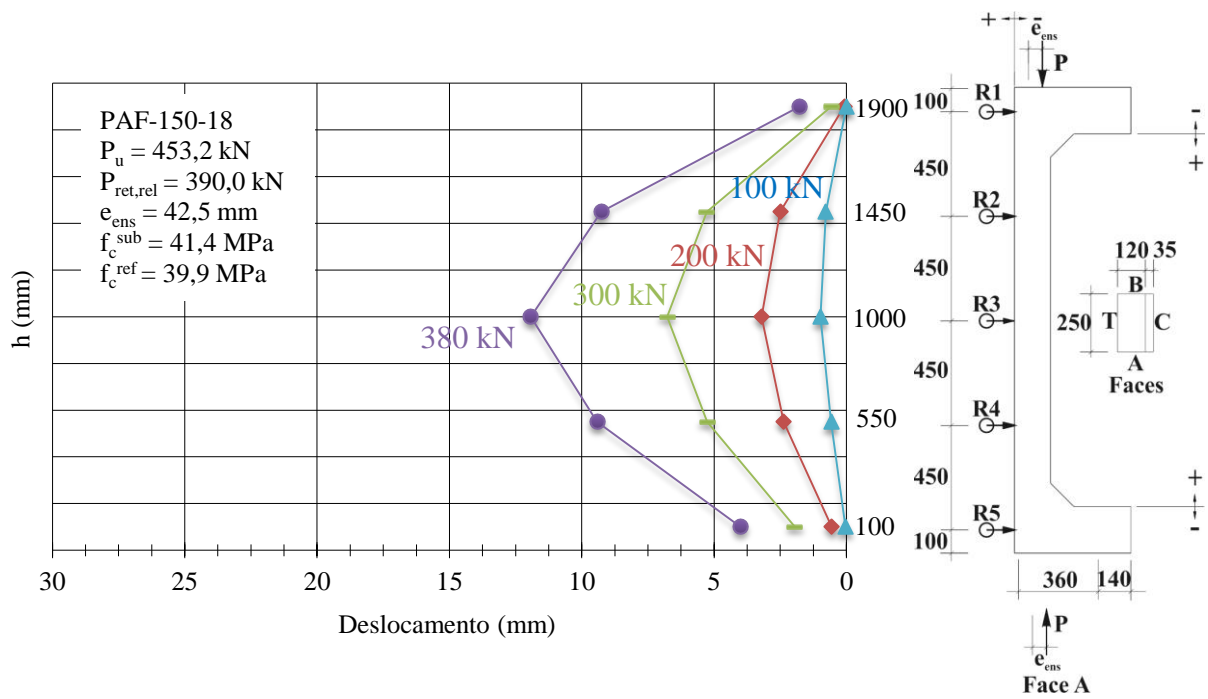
4 - Deslocamentos horizontais R1 a R5 – pilar PAF-150-18
